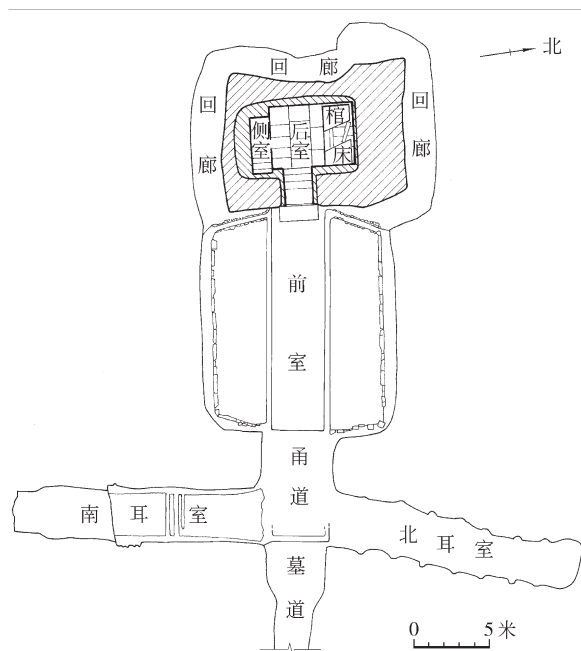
河北省满城陵山 1 号墓平面图 (1/500)
